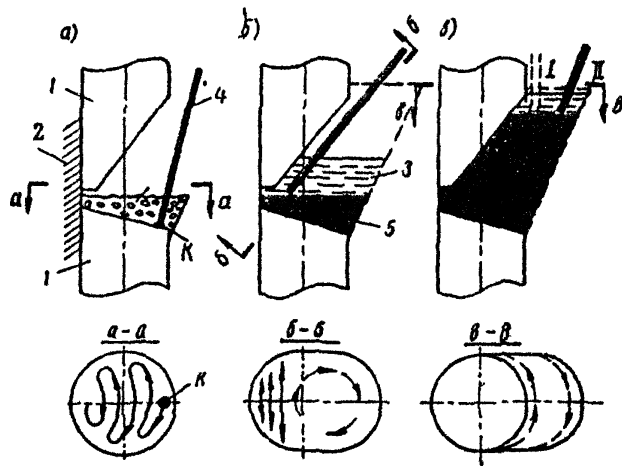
Техника вапной сварки под флюсом стыковых соединений вертикальных стержней диаметром ≥ 32 мм
